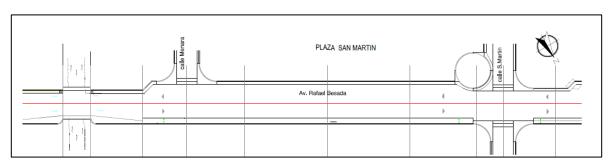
Planta tramo Besada entre alcantarilla y pavimento existente (s/proyecto de CAFESG)
